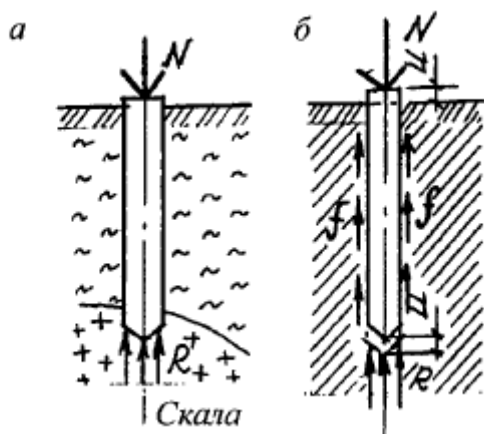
Характер работы свай в фундаменте: а - сваи-стойки; б - свай трения
